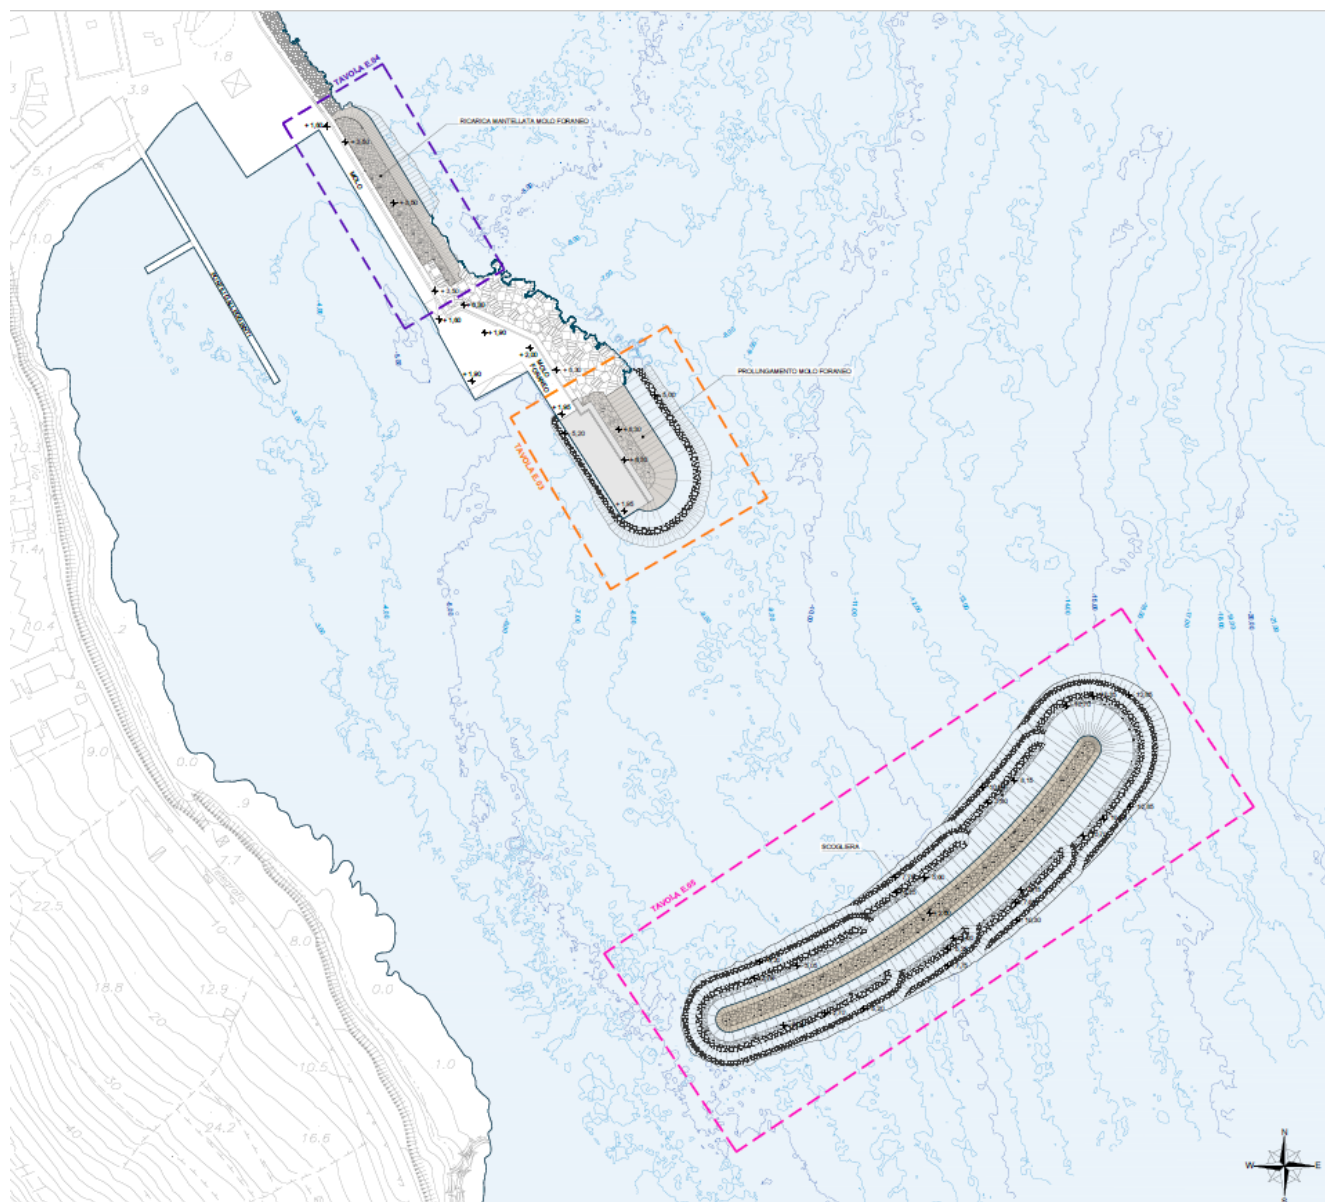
Planimetria generale di progetto. La scogliera di protezione dai venti provenienti dal II quadrante è stata stralciata dal progetto
